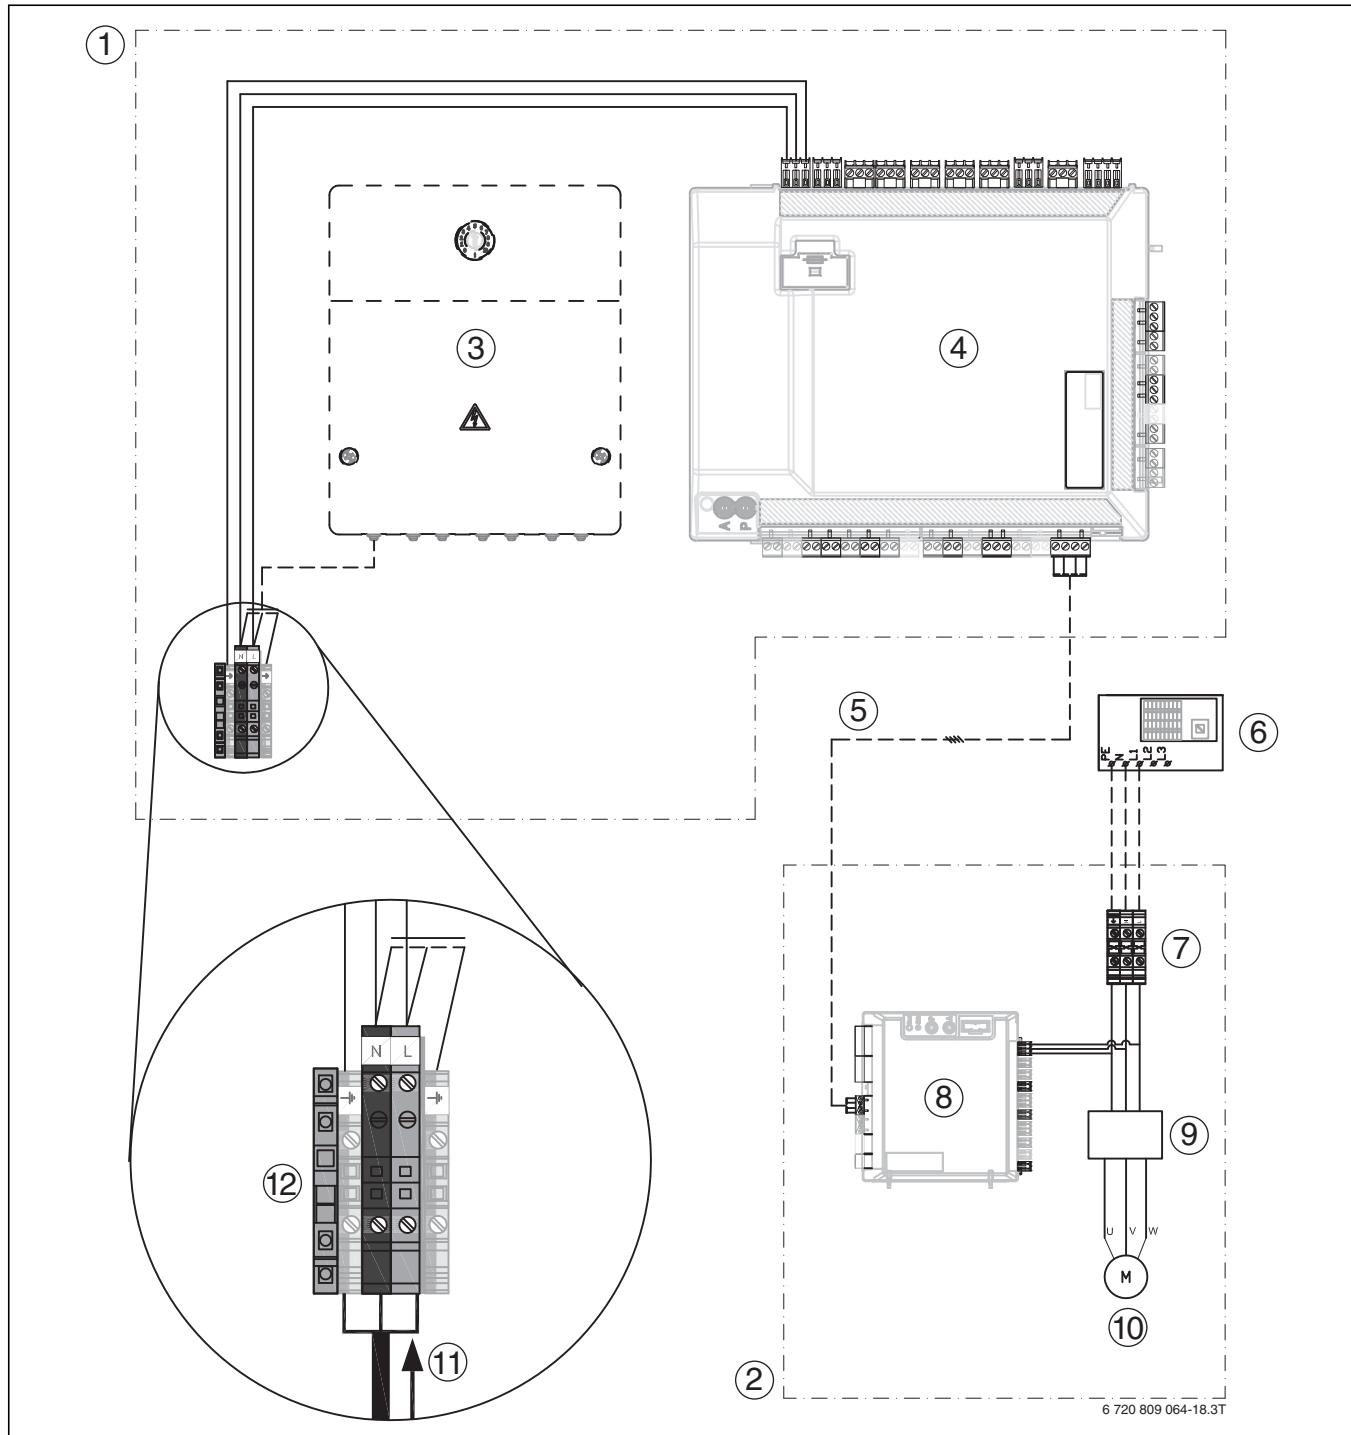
Внутренний блок с отдельным нагревателем - обзор
